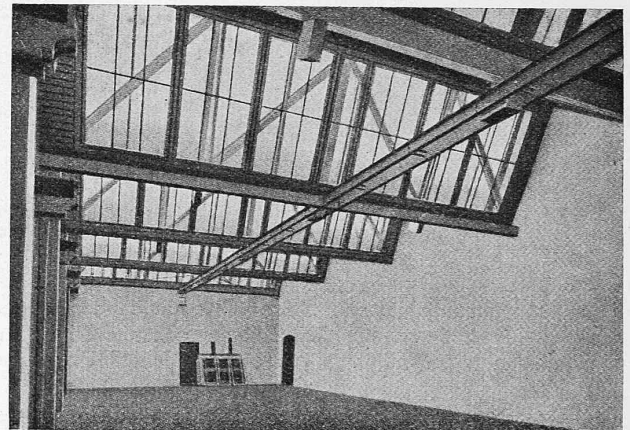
Hölzerne Sheddach-Konstruktion einer Fabrik.
